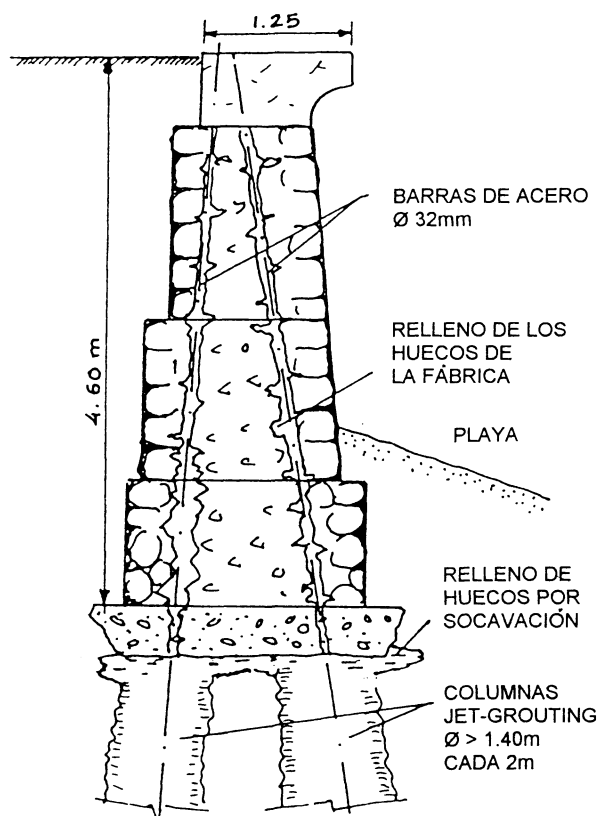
Recalce por jet-grouting del muro de la Playa de San Lorenzo (Gijón).
